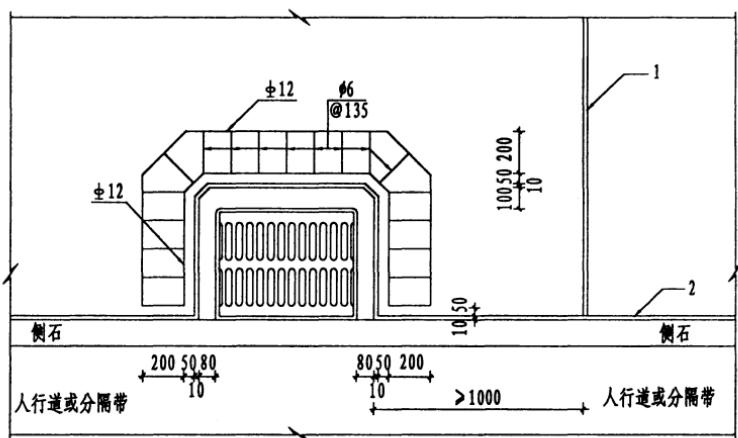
雨水口周围的面层配筋(尺寸单位:mm)
